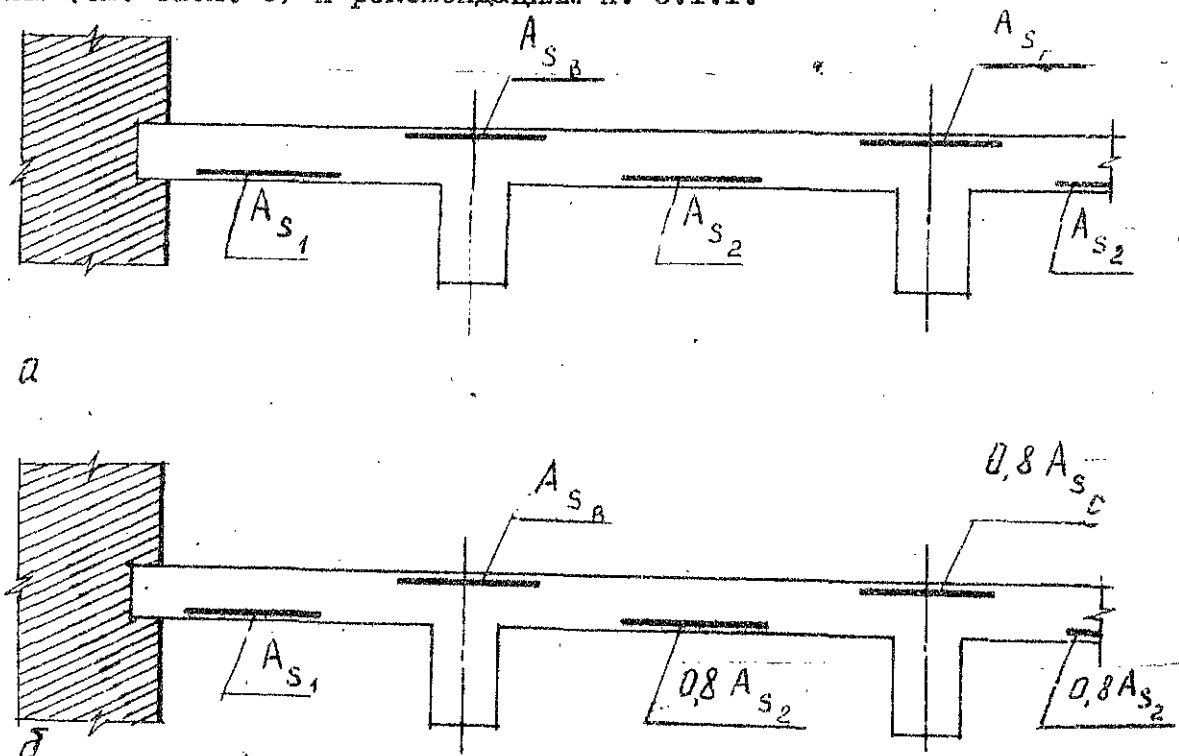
Расчетное сечение арматуры A_s в растянутых зонах плиты: а — неокаймленной балками по контуру; б — окаймленной балками по контуру
